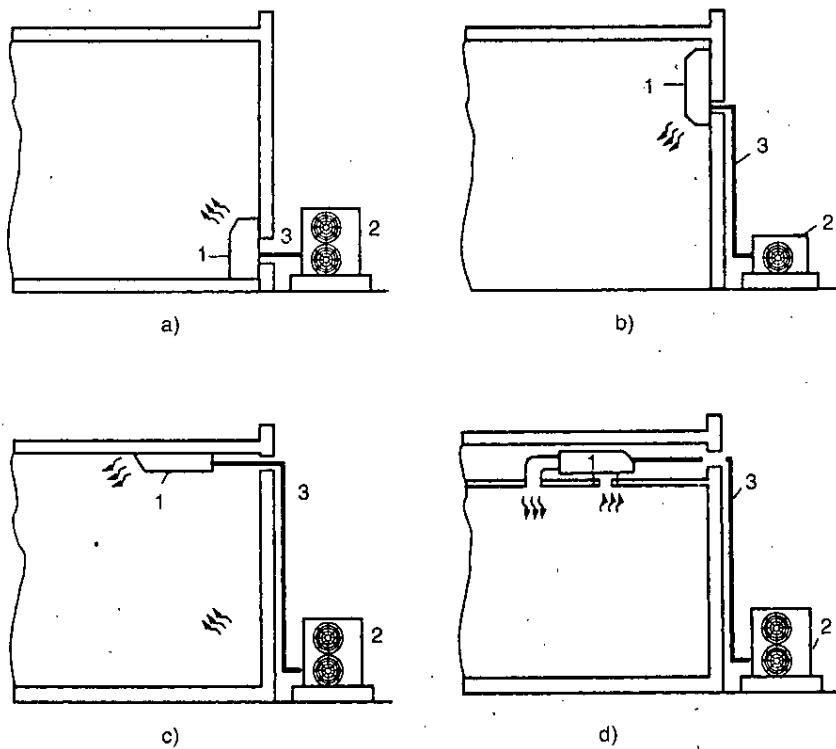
Máy điều hoà kiểu tủ tường (slim packaged air conditioner)
